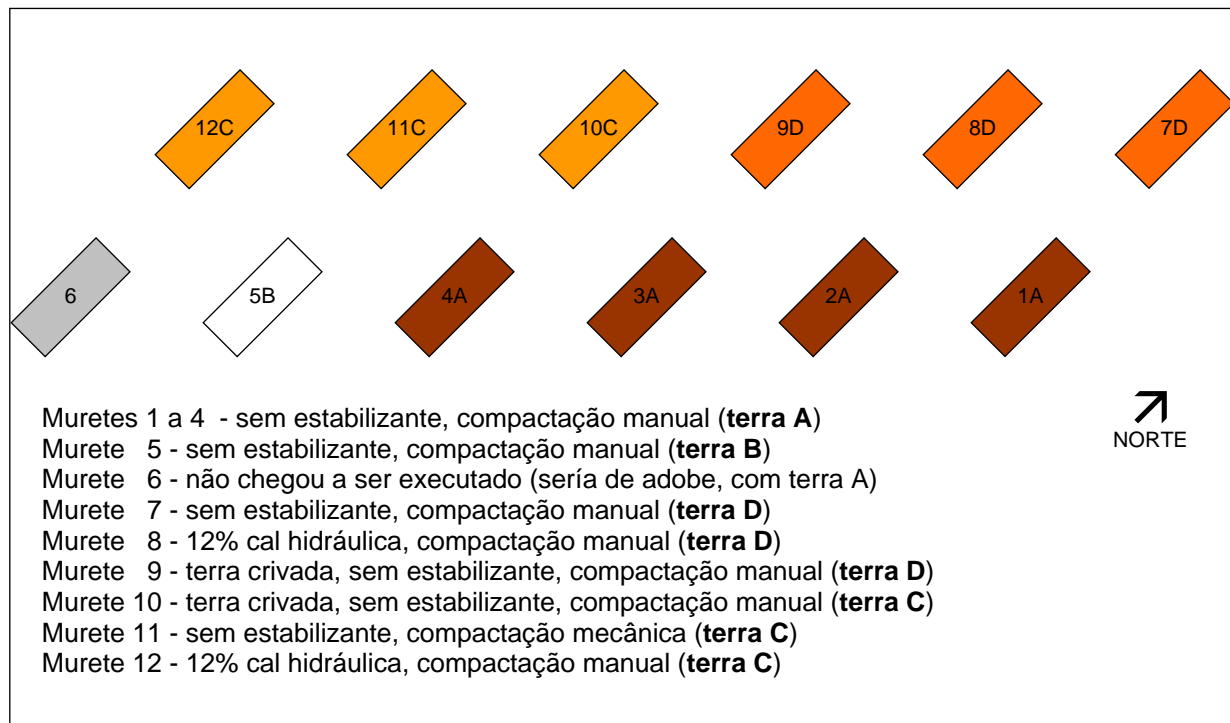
Configuração, implantação e orientação do parque de muretes da Herdade da Bemposta.
